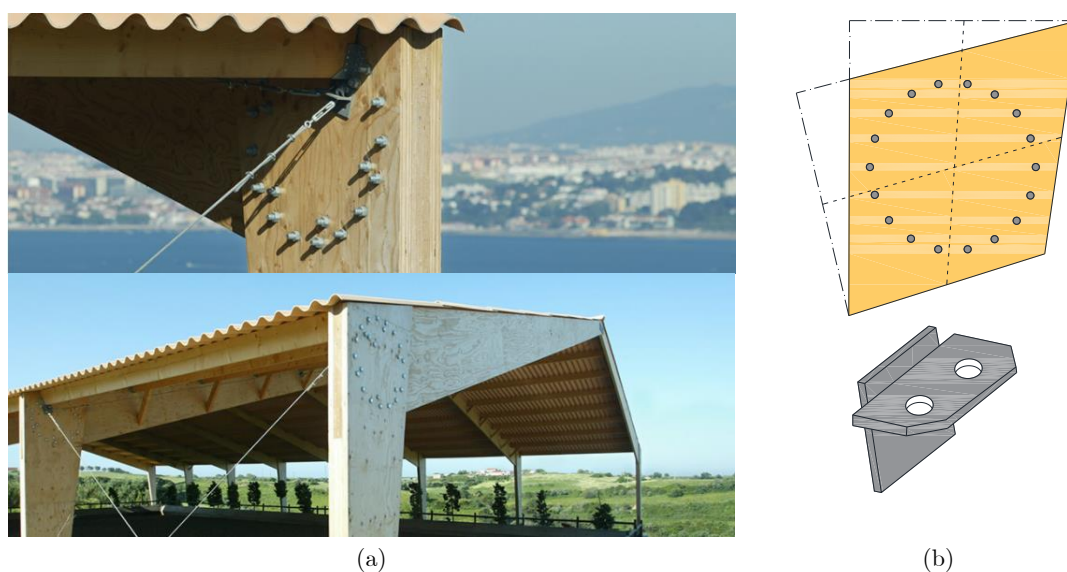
Ligações coroa e tirante a)– Picadeiro Almada [Adaptado (Jular, 2021)]; b) ferragem ligação dos tirantes e pormenor da coroa.
